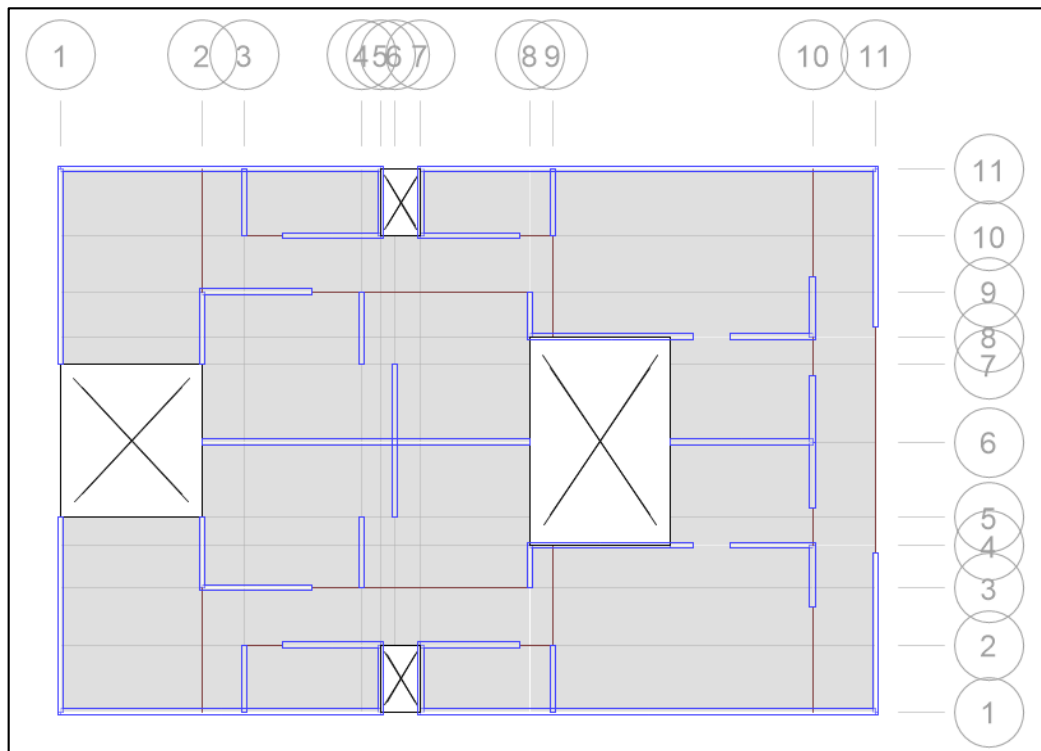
Vista en Planta del Sistema de Muros de Ductilidad Limitada
